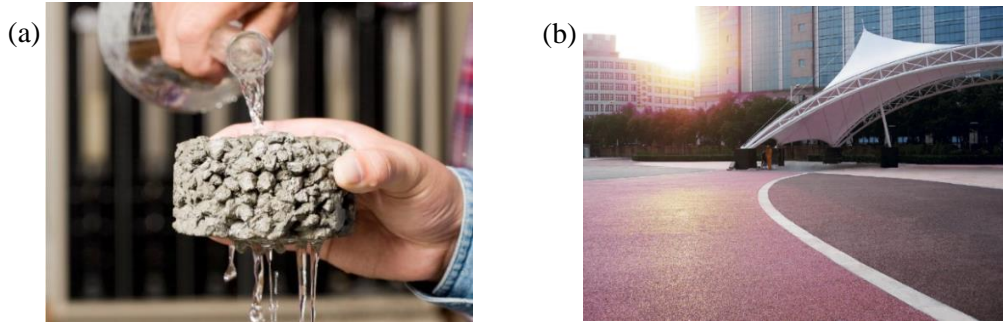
Usos de hormigones permeables. (a) Demostración de permeabilidad de una muestra de hormigón permeable (Fuente: Tomada de Washington Concrete, s.f.). (b) Secciones de hormigón permeable de color en la zona de preparación de los juegos olímpicos en el centro de Beijing (Fuente: Tomada de Mitchell, 2010)
